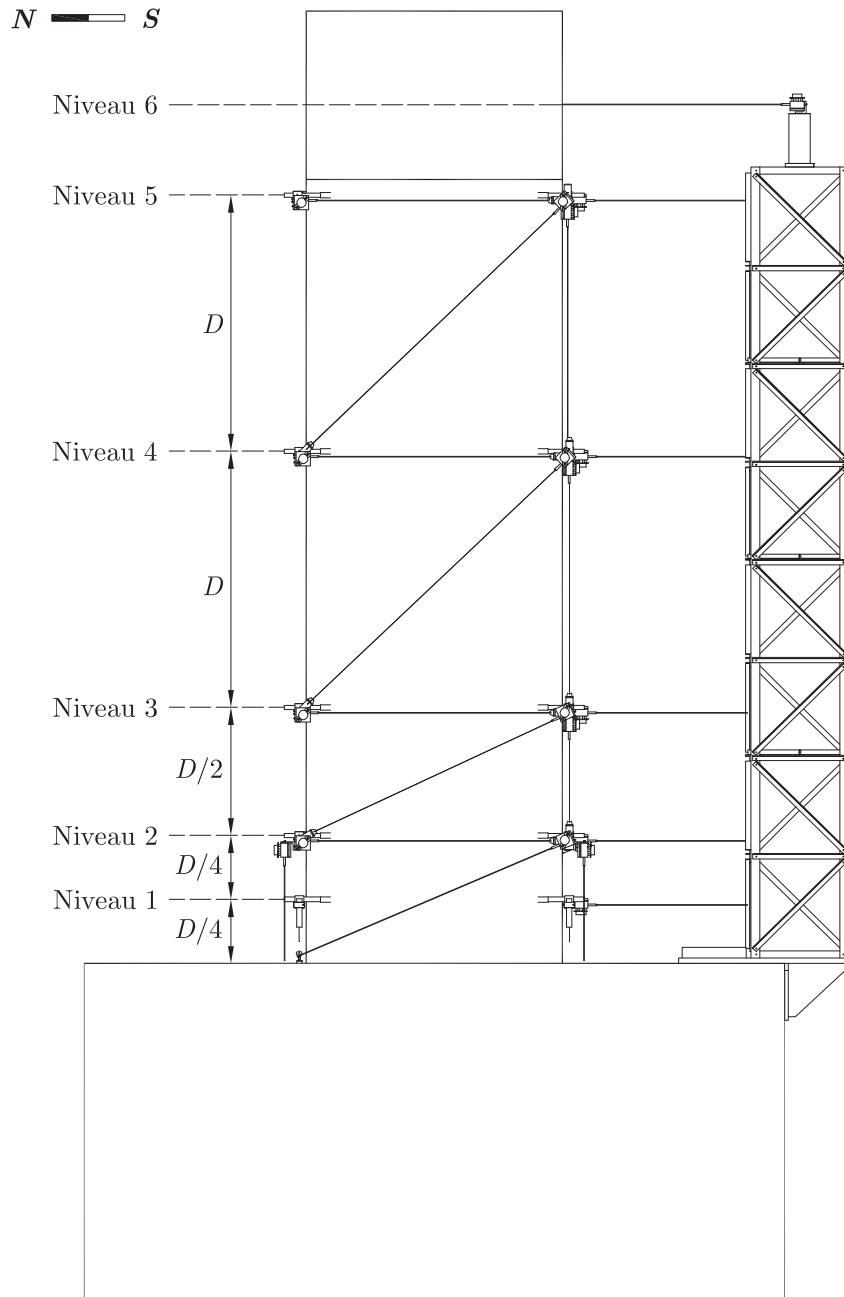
Vue de côté ouest du pilier instrumenté.
